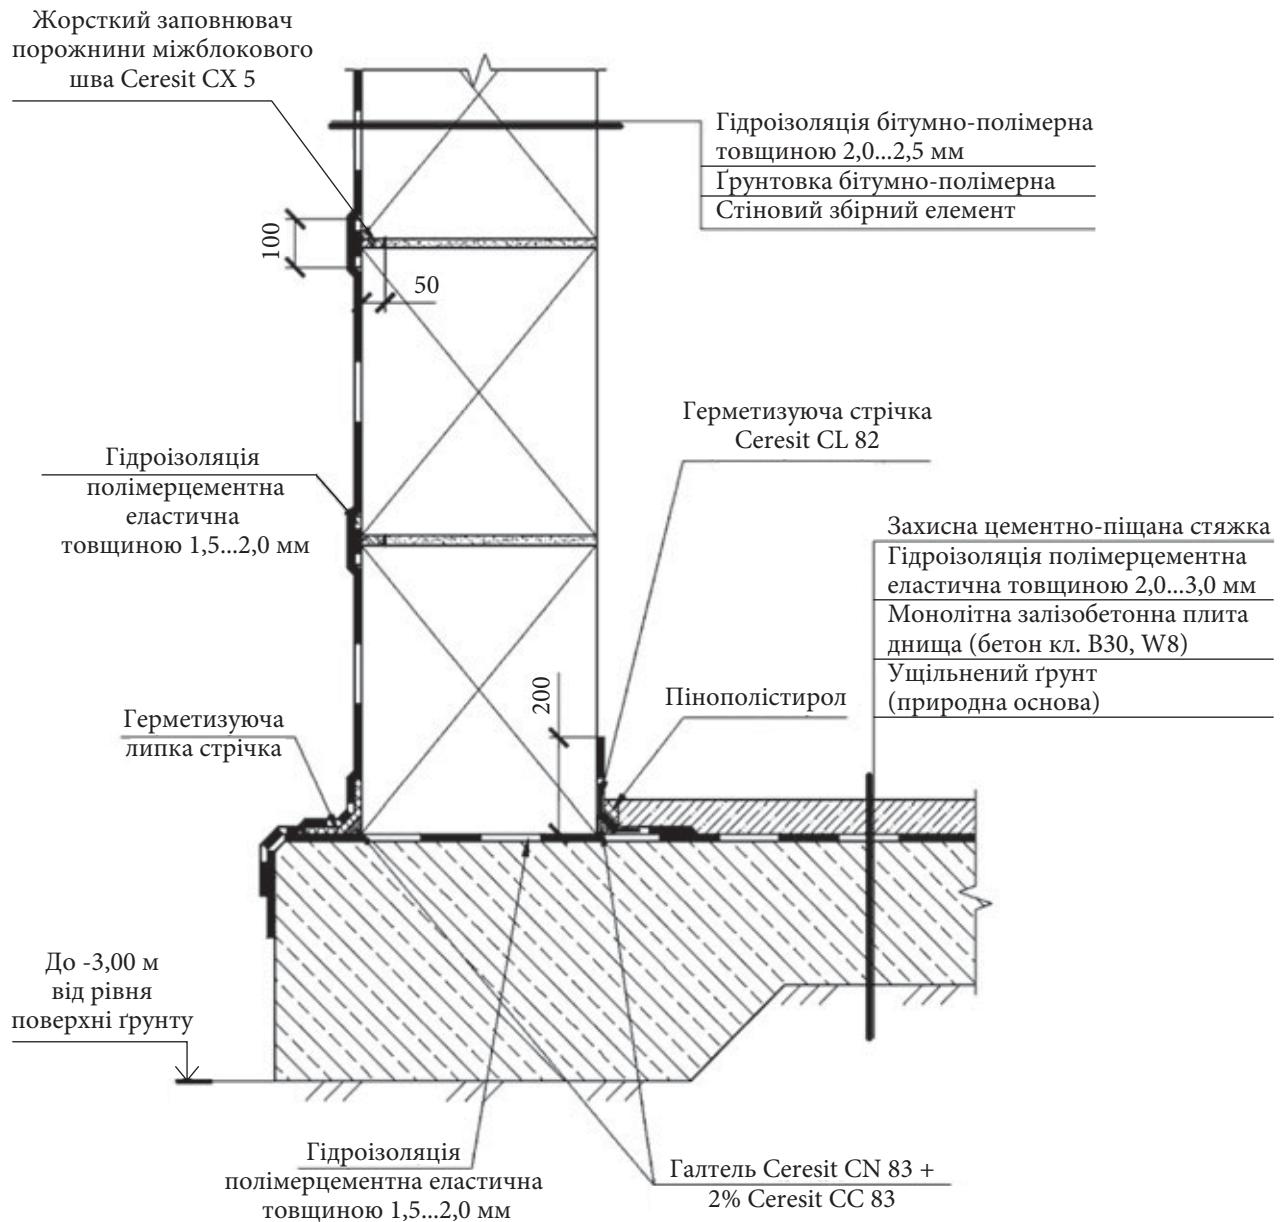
Гідроізоляція бетонних плит основи і стін підземних збірно-монолітних споруд в умовах впливу ґрунтової вологи
